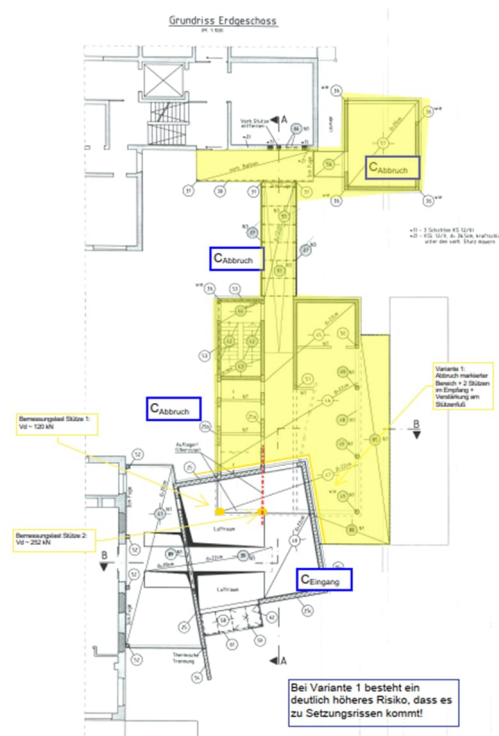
Auszug aus dem Positionsplan Erdgeschoss P3b vom 24.02.2003
